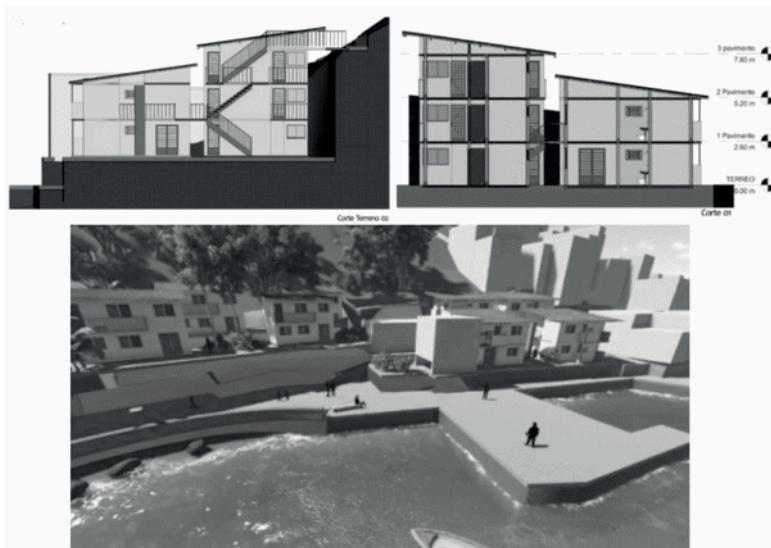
Perspectiva do projeto ZANOLI/2015 em detrimento das muralhas de pedras do Porto da Gamboa
